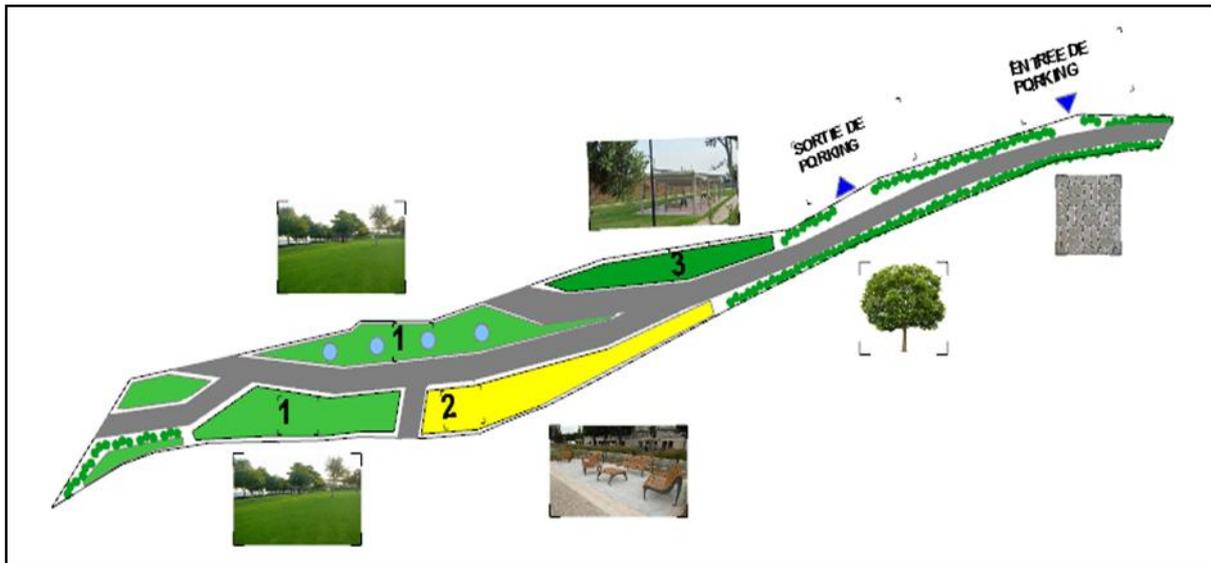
Plan d'aménagement de l'esplanade. Source : auteur.
